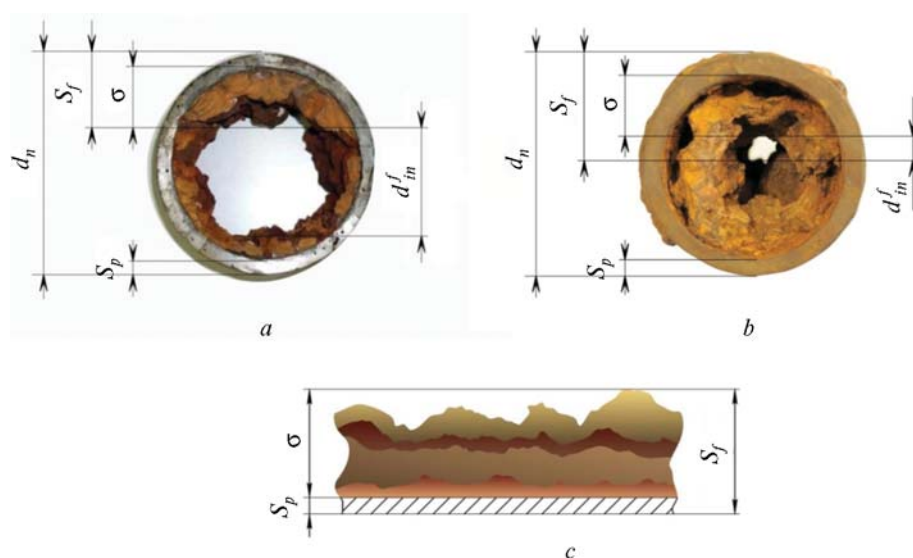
Фрагмент отложений на стенках стальных труб (а) и на стенках труб из серого чугуна (б)
